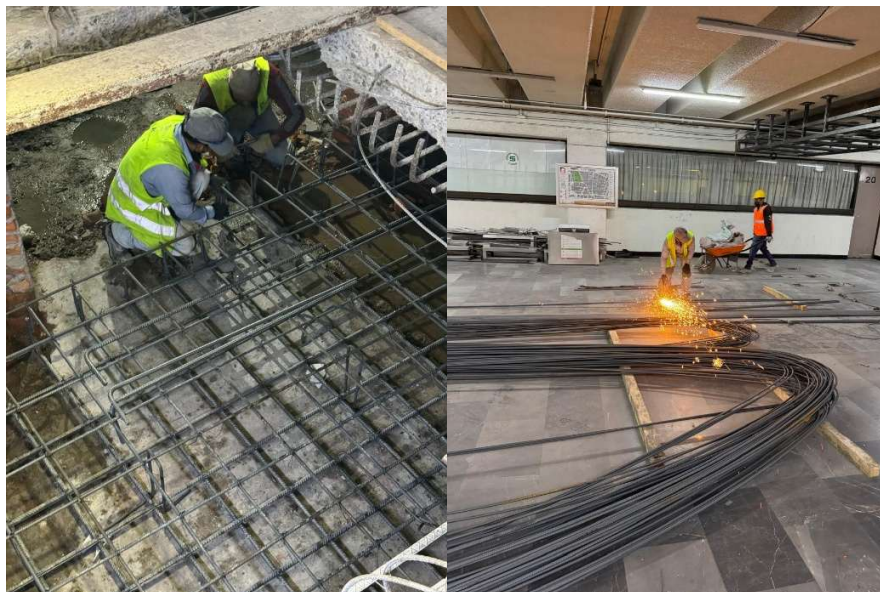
Habilitado y armado de refuerzo para cimentación de elevador. Elaborado por el autor.
